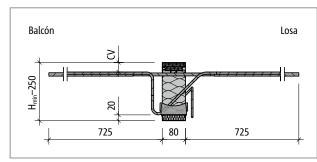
Schöck Isokorb® T tipo K-M7 hasta M11: Sección del producto
